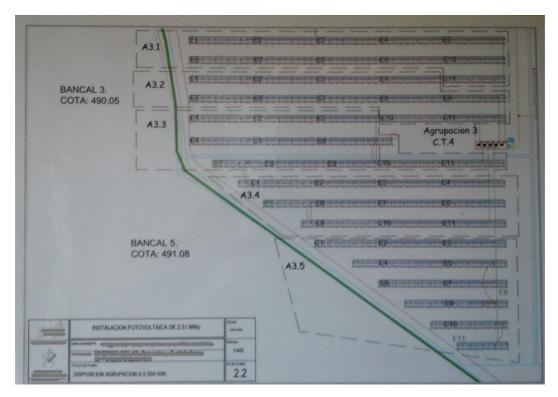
Plano de una instalación fotovoltaica conectada a red. Foto propia.
